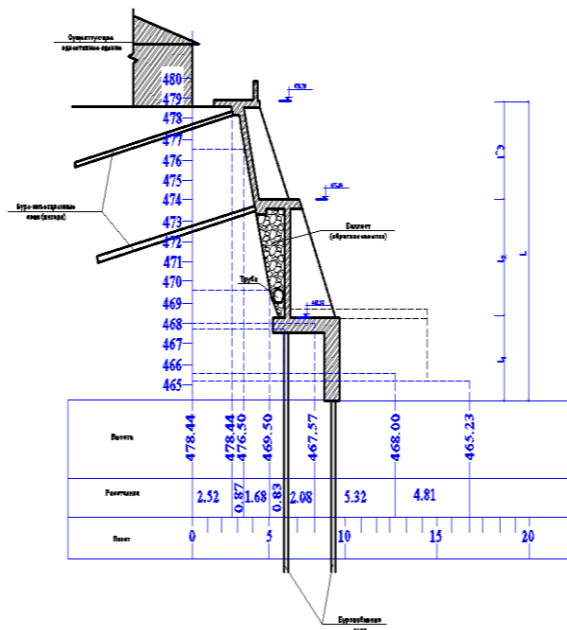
Поперечный разрез одевающих (прижимных) подпорных стен на свайном фундаменте. Вариант III
